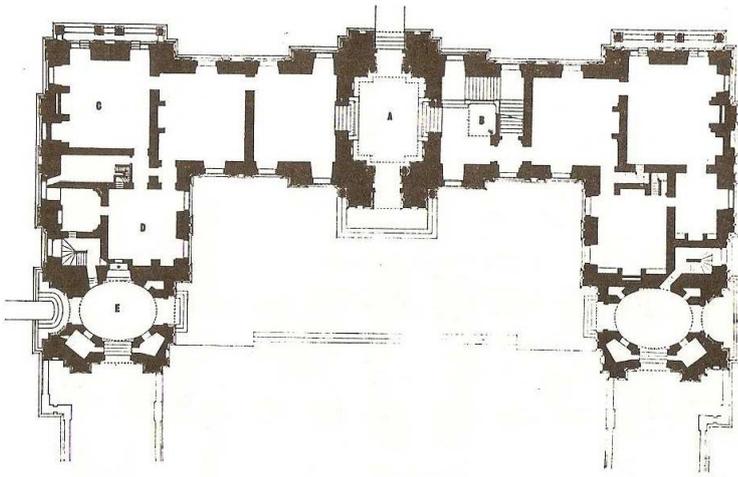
Maisons-Laffitte, Grundriss Erdgeschoss
